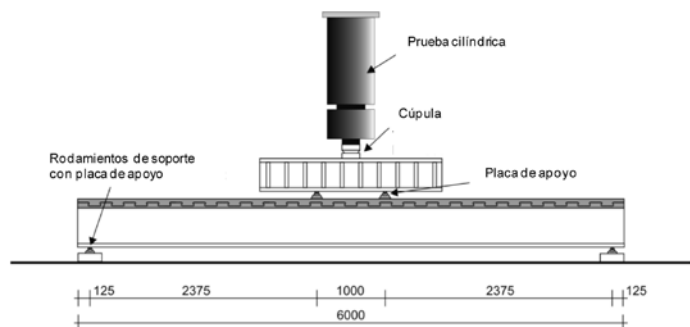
Montaje del ensayo a flexión de la viga HEM900
